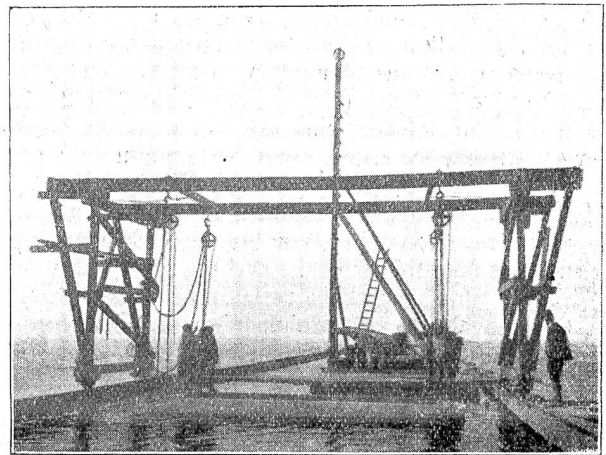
Laufkran, mit Betonelement, vor dem Absenken.
